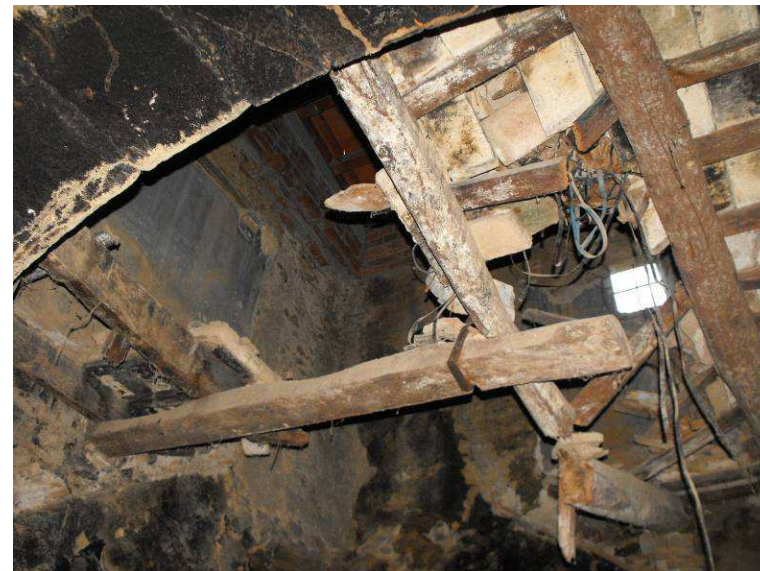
Col·lapse del sostre de planta baixa.
